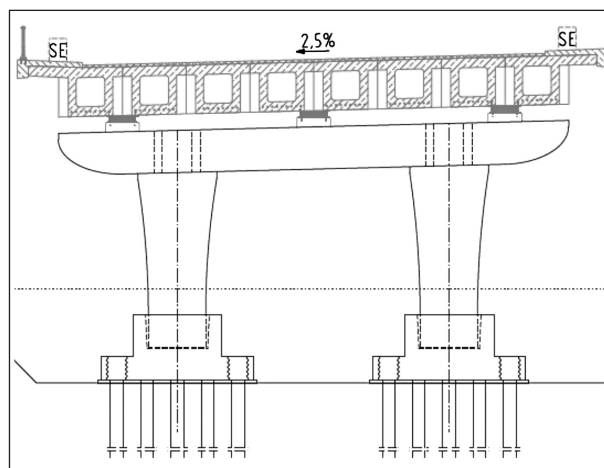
Ansicht, Vollquerschnitt in Köcherfundamenten, Gründung auf Spannbetonrammpfählen
